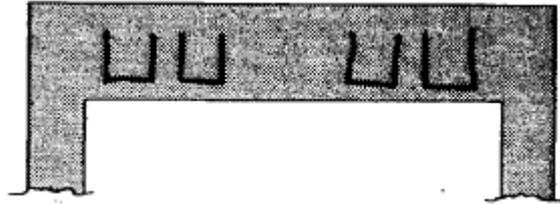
FISURAS DE FLEXIÓN Y CORRIMIENTO EN EL ACERO DE REFUERZOS
